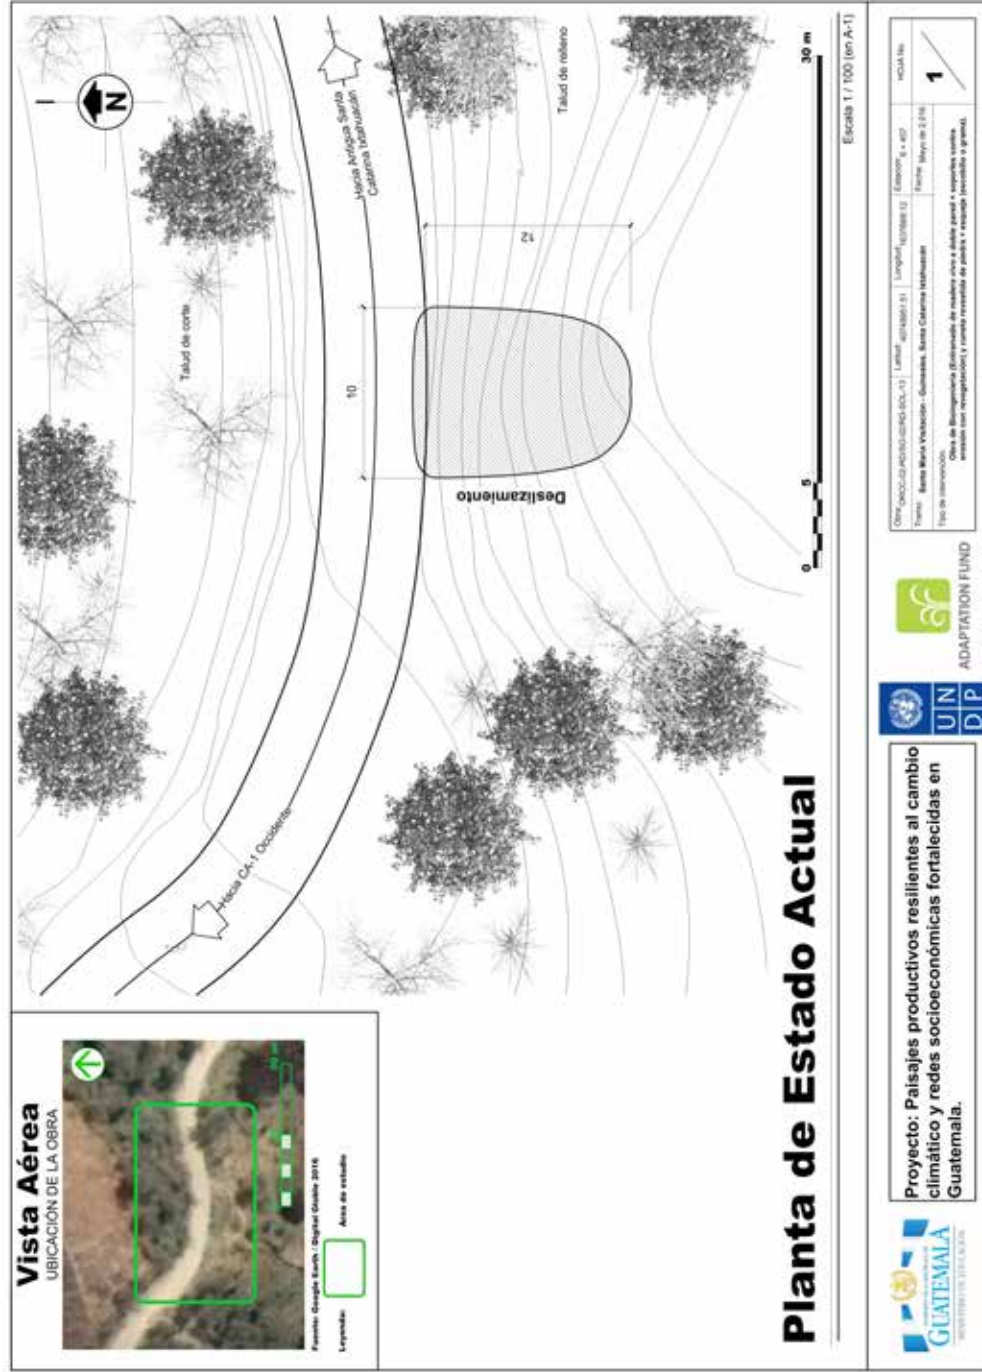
A. PLANTA ESTADO ACTUAL. Planificación Obra ORCC-02/RD-SOL-02 y RD-SOL-13. Tramo: (CA-01 Occidente/ KM-163-Cruz Bé/ Bifurcación Santa María Visitación)
